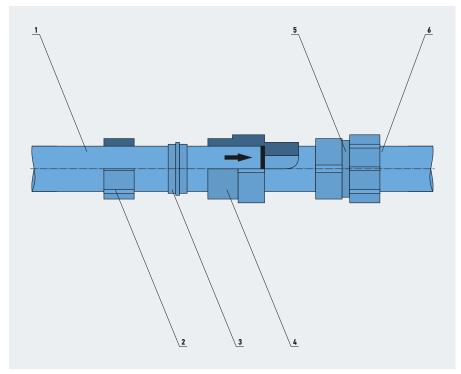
Разъемное соединение двух труб из ПВХ-Х (1, 6 — трубы из ПВХ-Х; 2 — накидная гай-ка; 3 — резиновый уплотнитель; 4 — устройство с наружной и внутренней резьбой; 5 — гайка с наружной резьбой)
